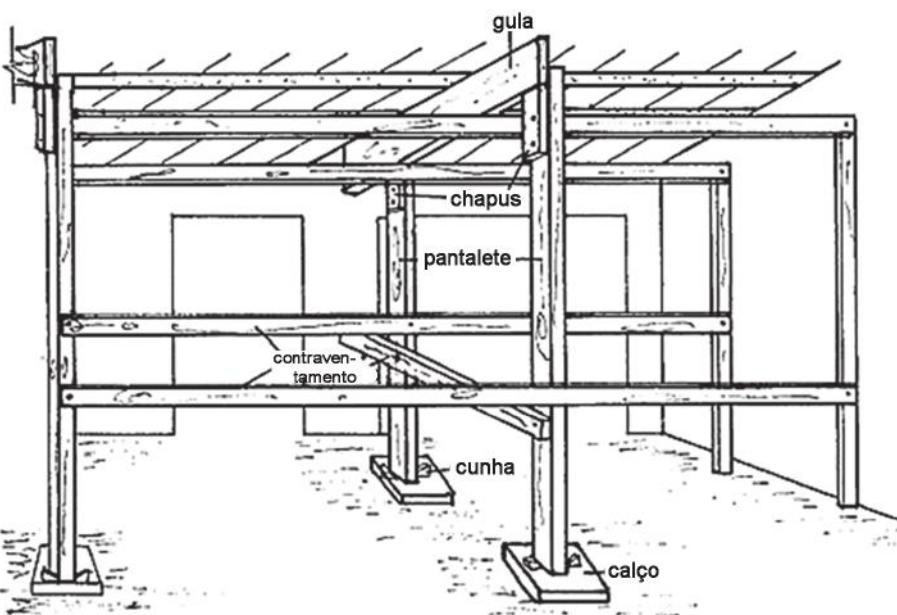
Exemplo de escoramento para laje pré-fabricada.
